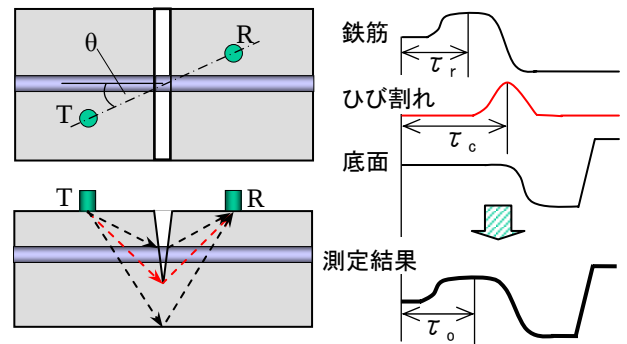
鉄筋コンクリートのひび割れ深さ測定
